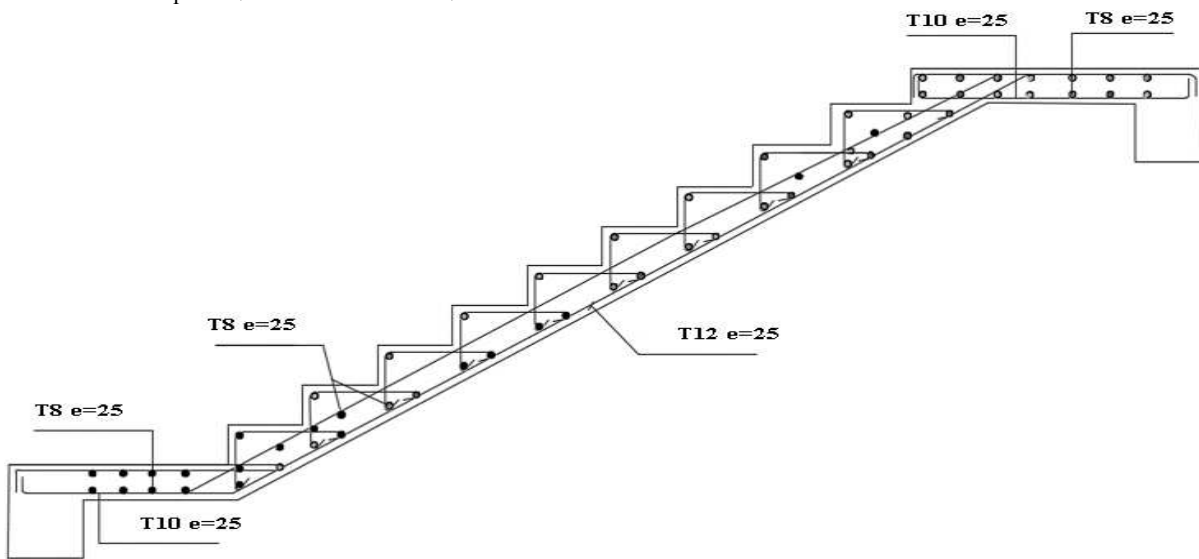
Ferrailage de l'Escalier (Volée I)
